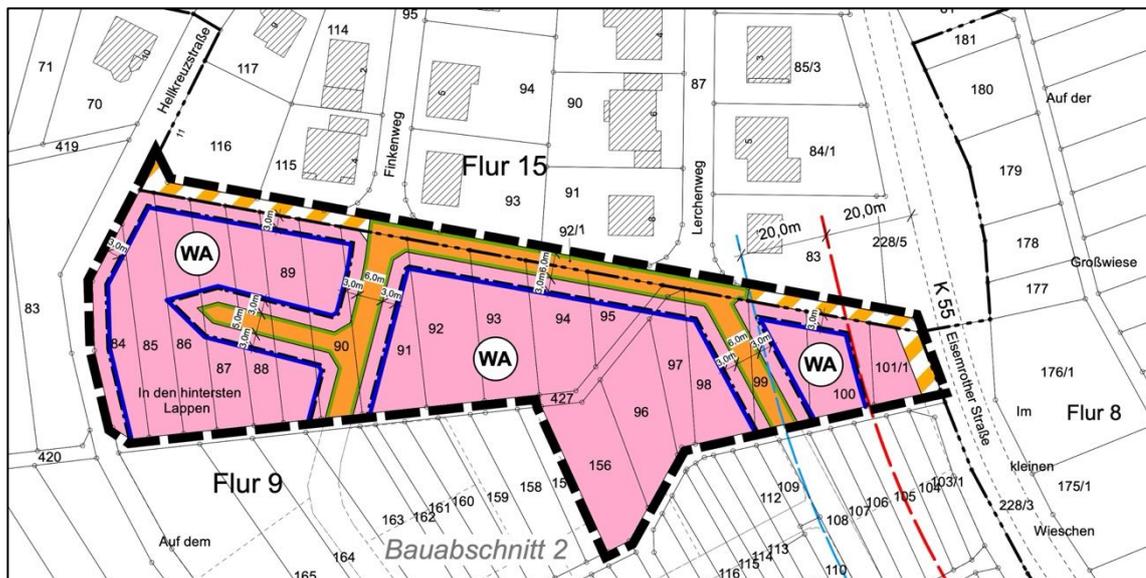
Bebauungsplan "In den hintersten Lappen" - Vorentwurf, Planteil
